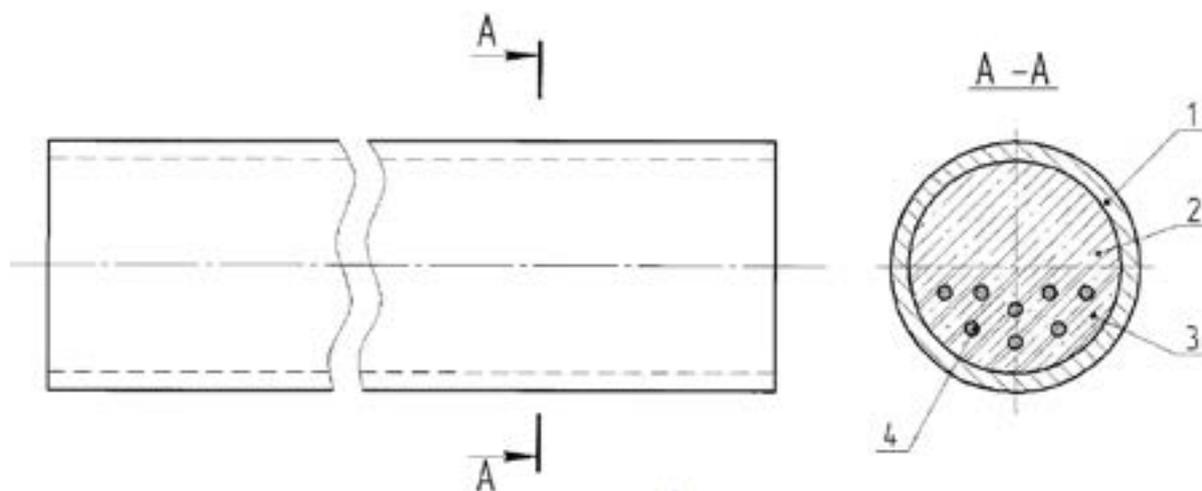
Предварительно напряженная балка по патенту № 2632798-труба; 2 – бетонный сегмент ядра; 3 – железобетонный сегмент ядра; 4 – армирующие элементы
